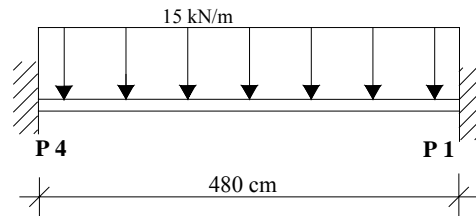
Esquema estático e carregamento no vão da viga adjacente ao pilar.
